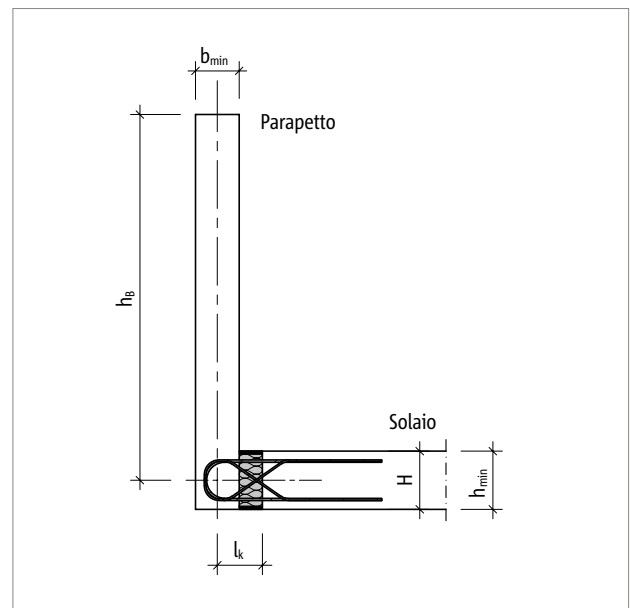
Schöck Isokorb® T tipo AP: sistema statico con altezza del parapetto  $h_b$ ; altezza  $H$  Isokorb®
